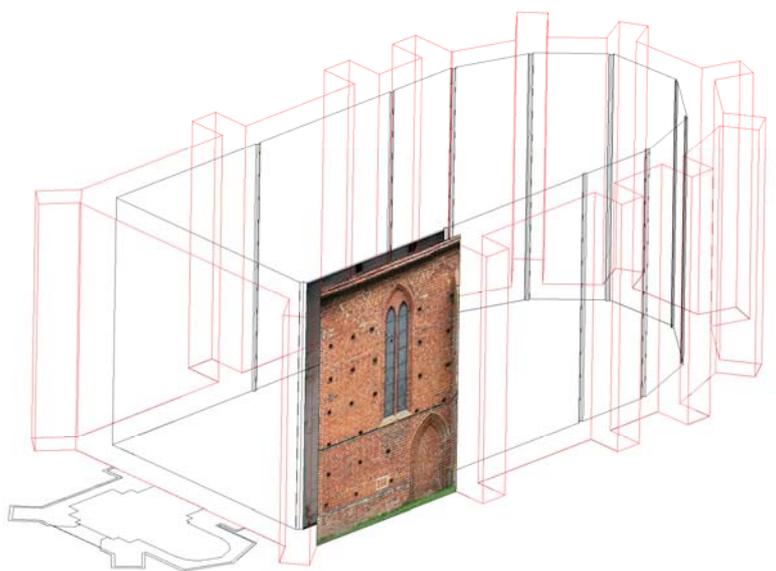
3D-Strichmodell mit entzerrtem Fassadenplan
